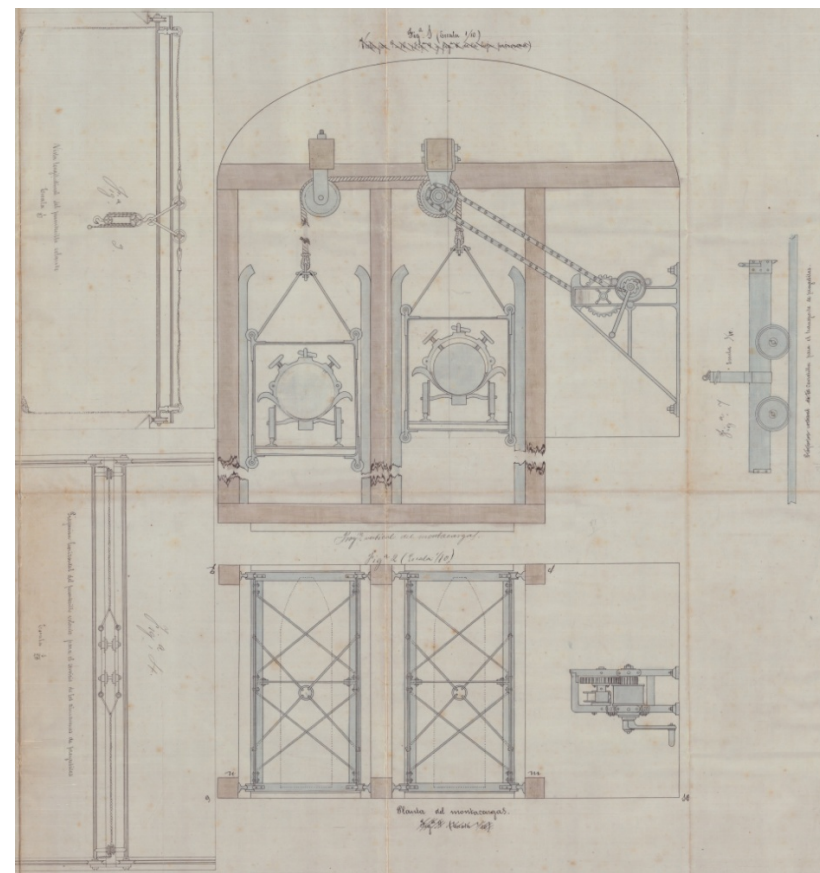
Detalles del montacargas de proyectiles.¹⁰³
